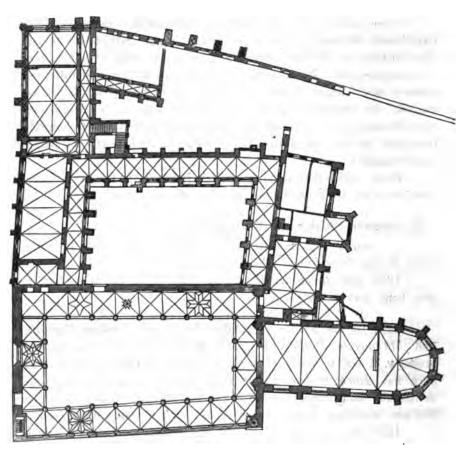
Johannis-Kloster. Grundriss. 1:667.
